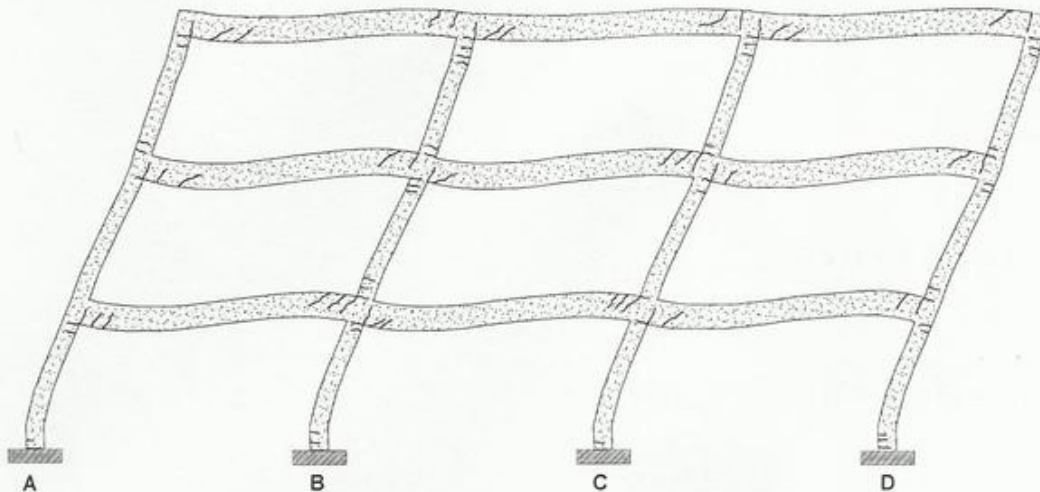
Deformada del pórtico bajo el sismo. Ejercicio 8.4
